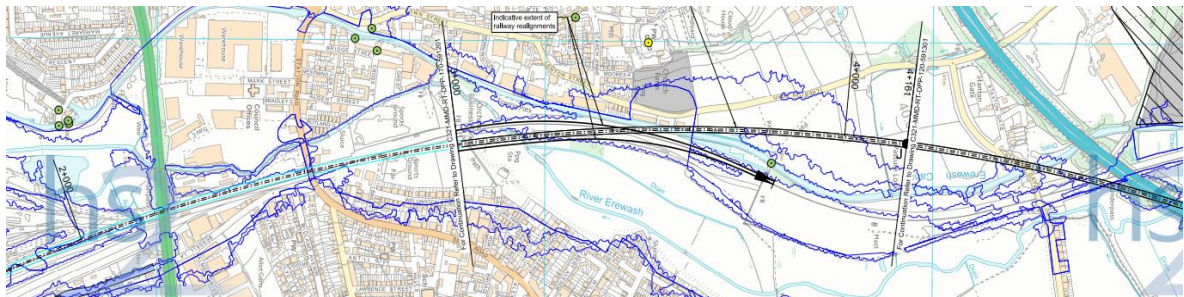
Planta do traçado viaduto sobre a bacia de cheia do Rio Erewash e Erewash Canal (Unido, HS2 Phase 2b: Long Eaton to Trowell route sheet 2).
